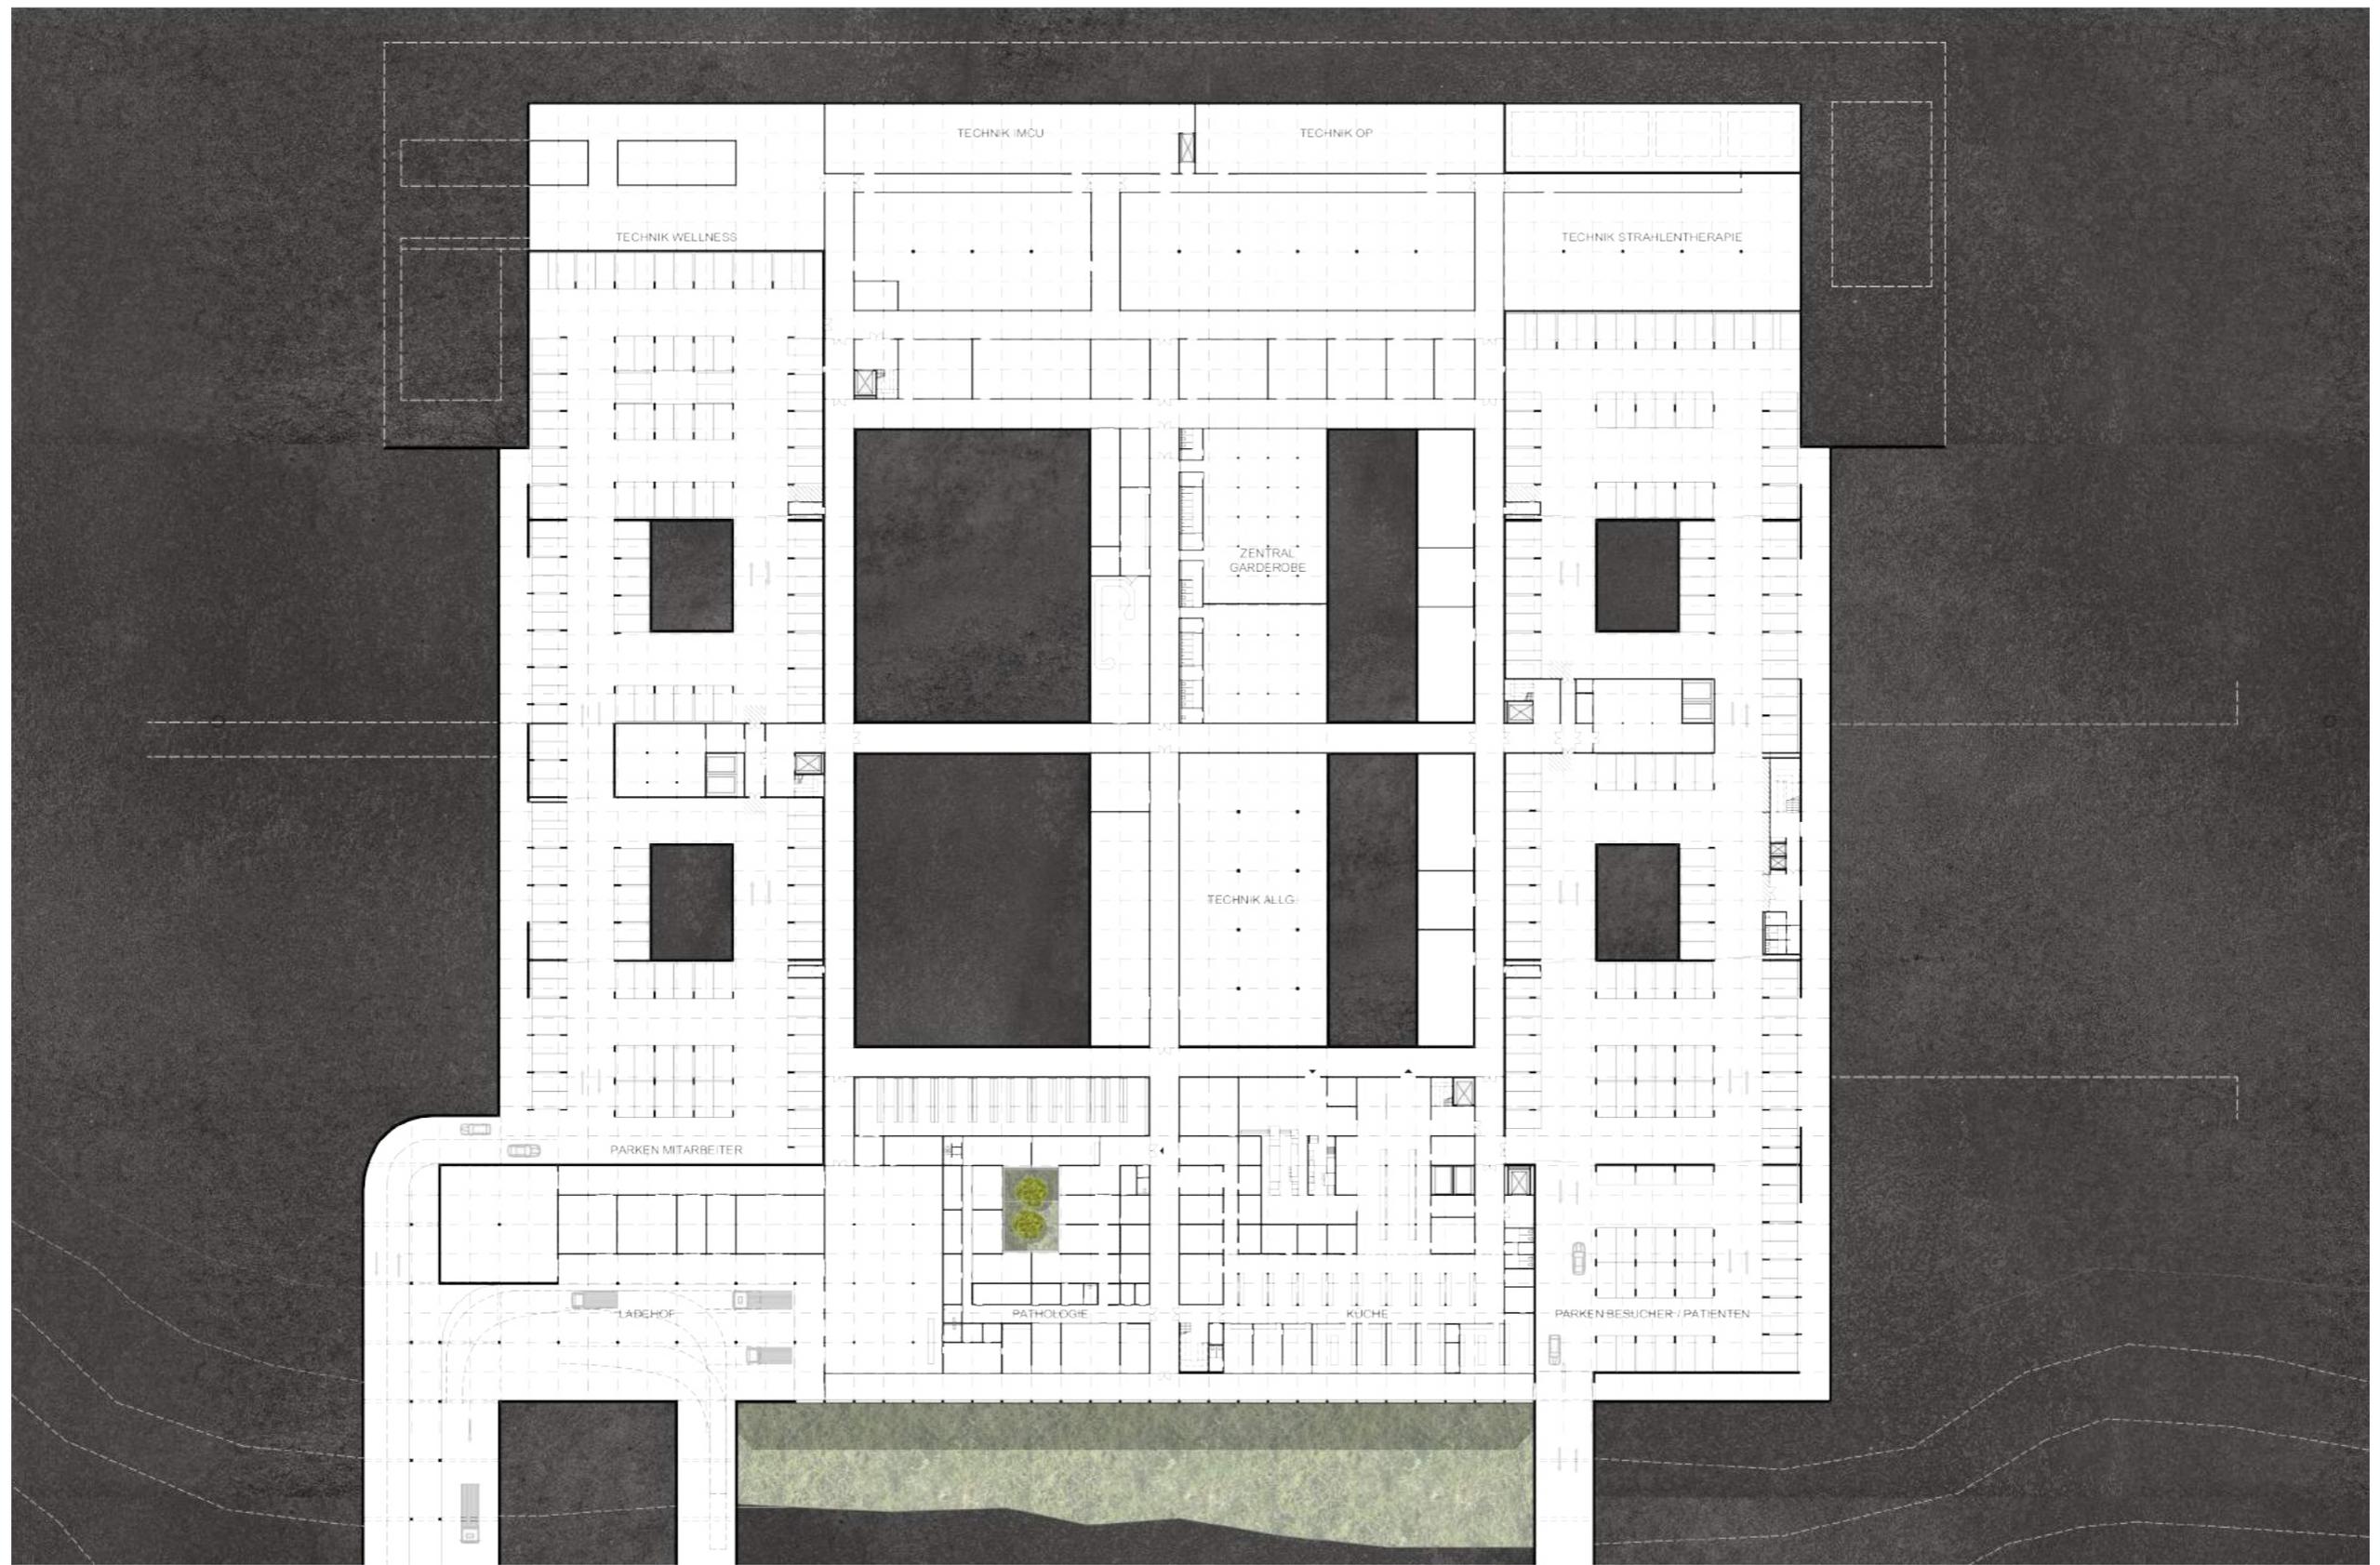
Grundriss Tiefgeschoß M 1:1000
